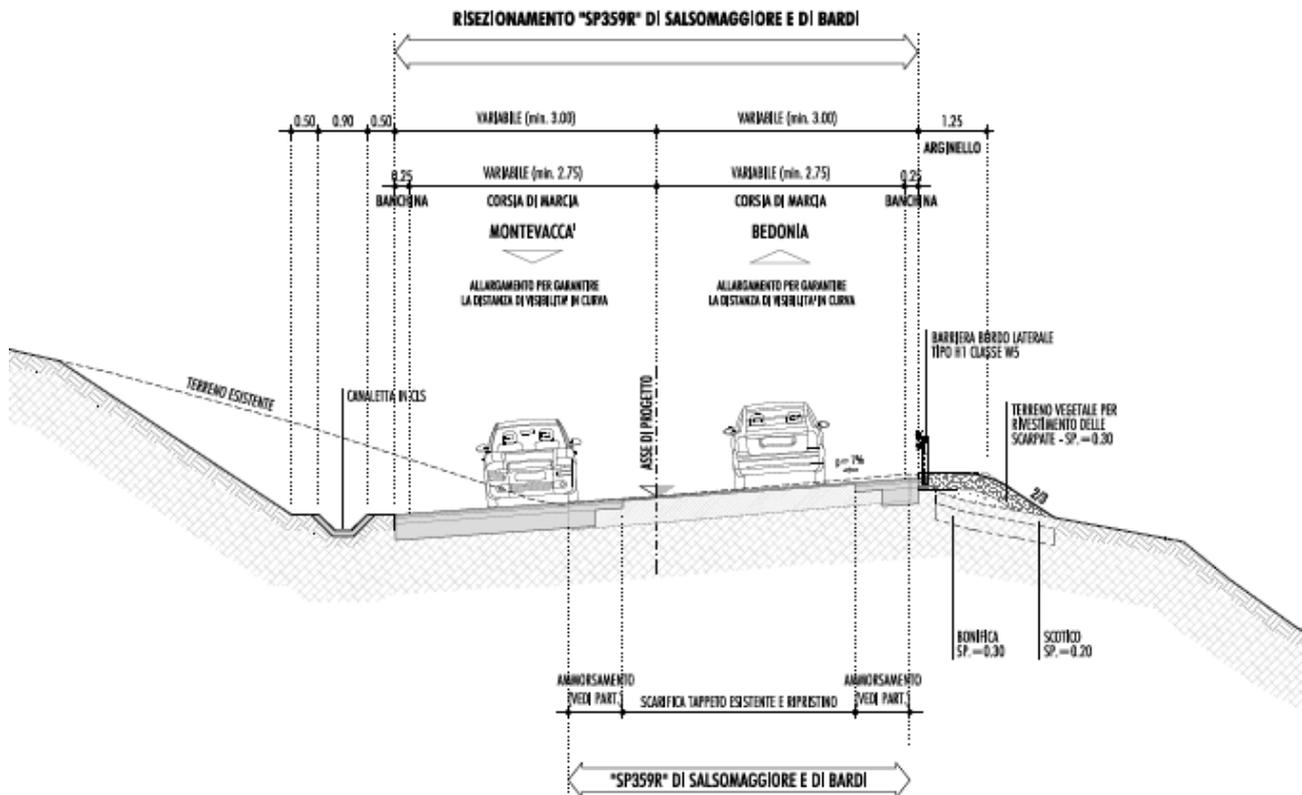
SEZIONE TIPO TRATTO 1 CON SCAVO LATO MONTE
